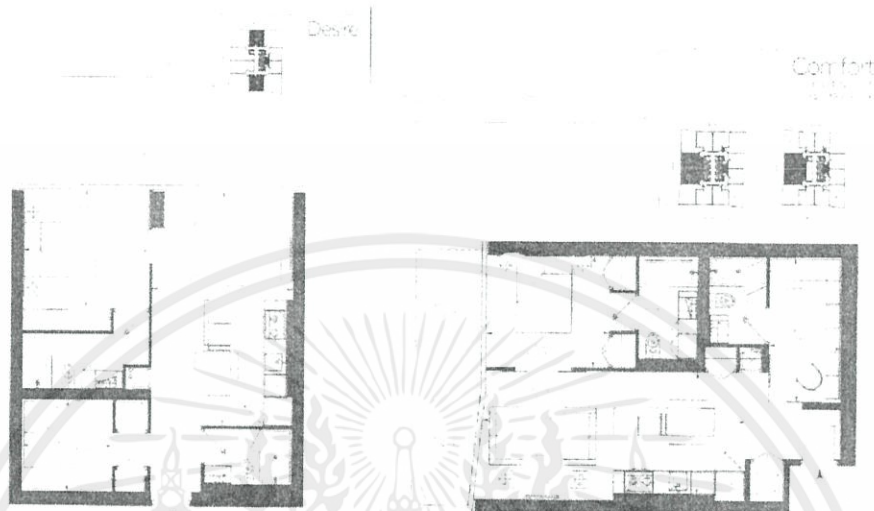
ผังโครงการชั้น 7 โครงการ One Bloor East
